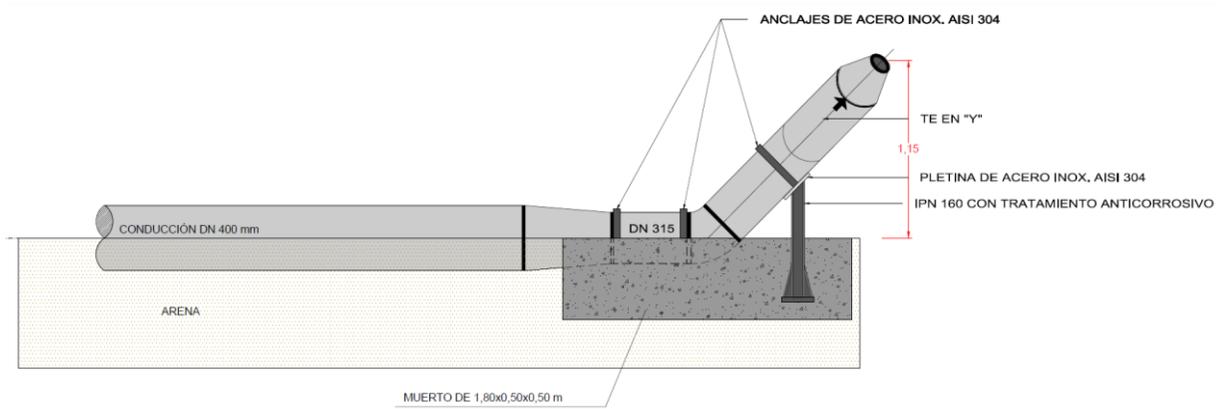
Detalle del sistema difusor (Alzado)
